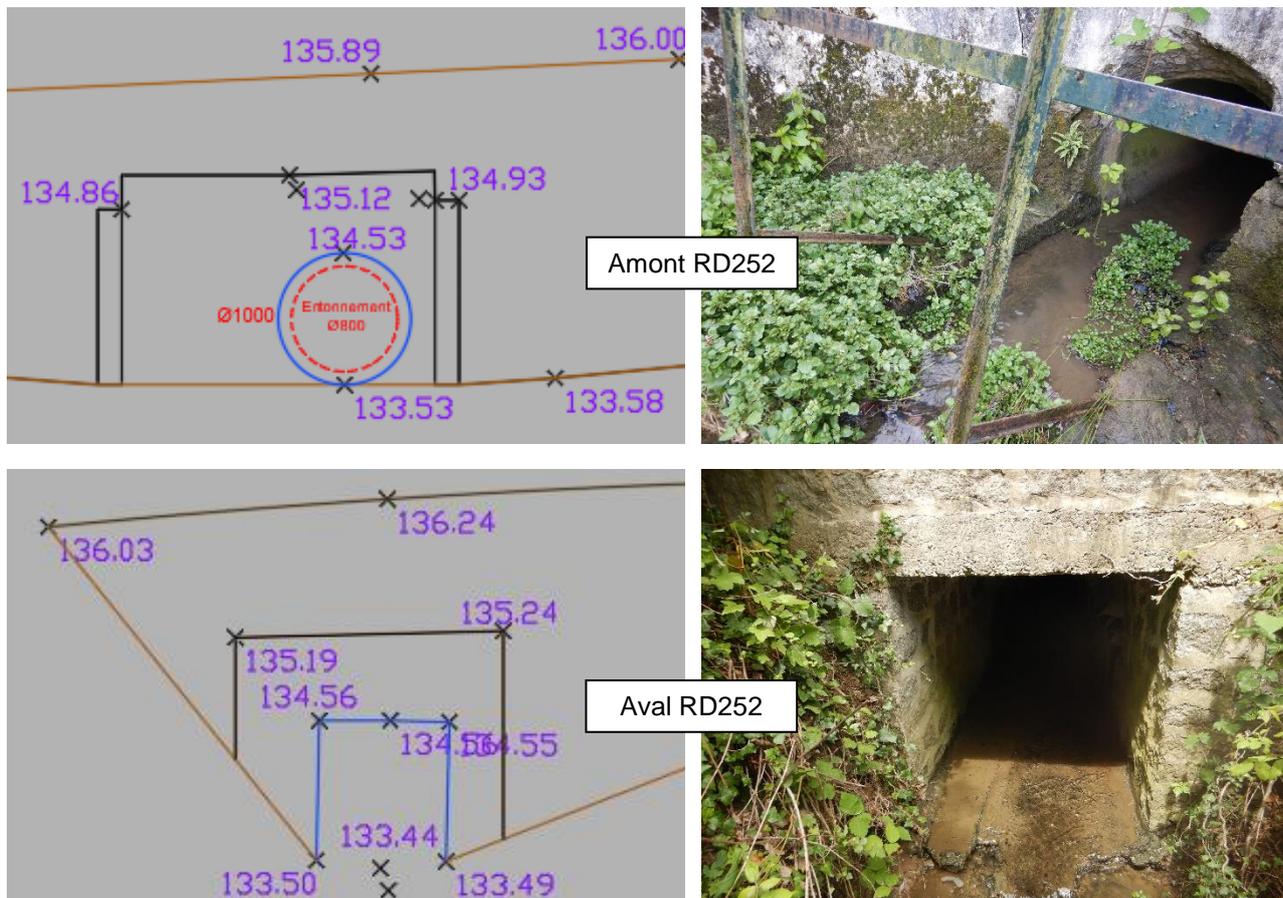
Plans et photographies de l'ouvrage exutoire du plan d'eau
